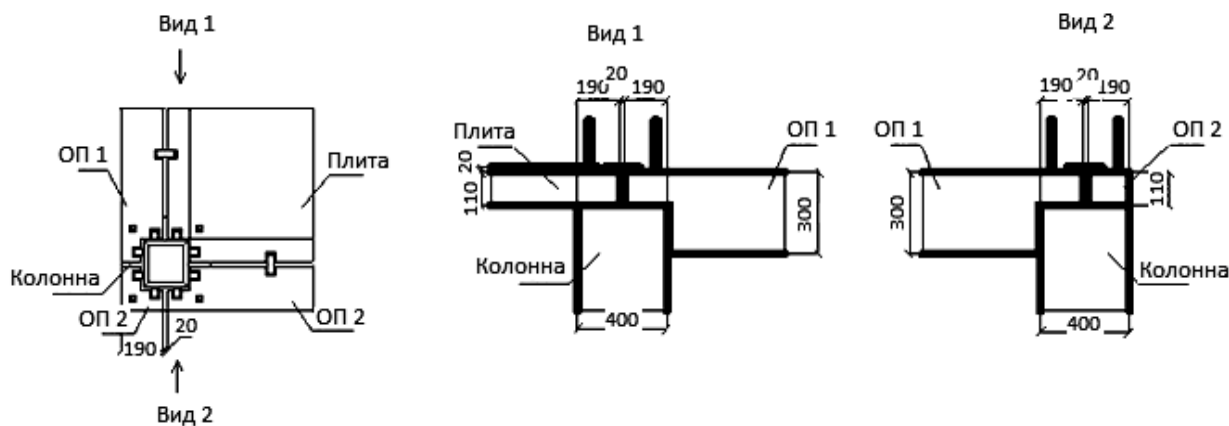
Узел сопряжения плит перекрытия с опорными вкладышами и колоннами
